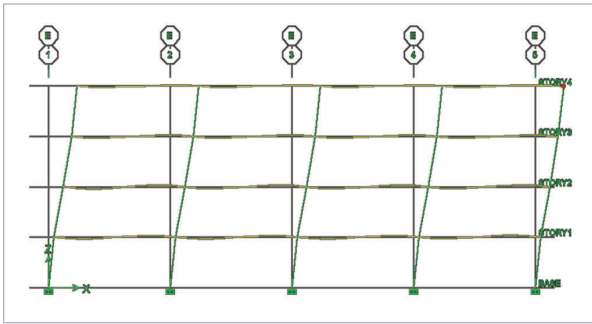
Deformación de la estructura bajo cargas sísmicas en dirección X
